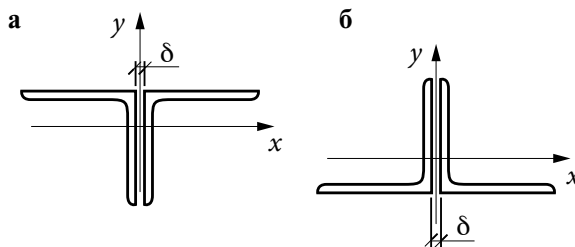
Сечение элемента фермы из парных уголков: а) для верхнего пояса; б) для нижнего пояса
